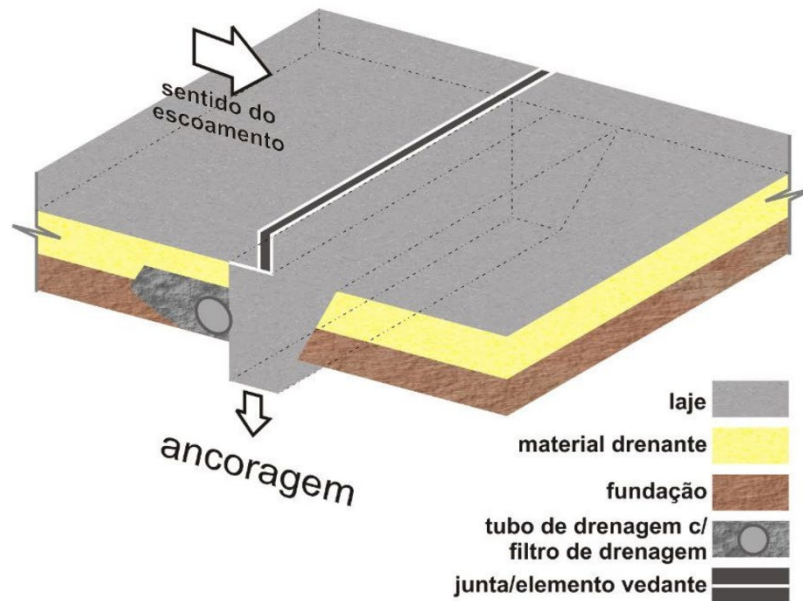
Esquema construtivo das lajes de uma bacia de dissipação. Mees (2008).
